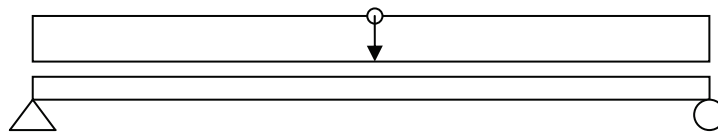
Den höga balkens längd utgörs av den längd som inte är fastgjuten i grundfundament.
